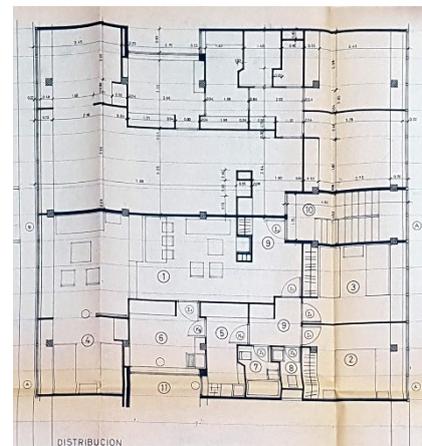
Planta Distribución B-2-3. 1964. Fuente: Archivo Municipal da Coruña
